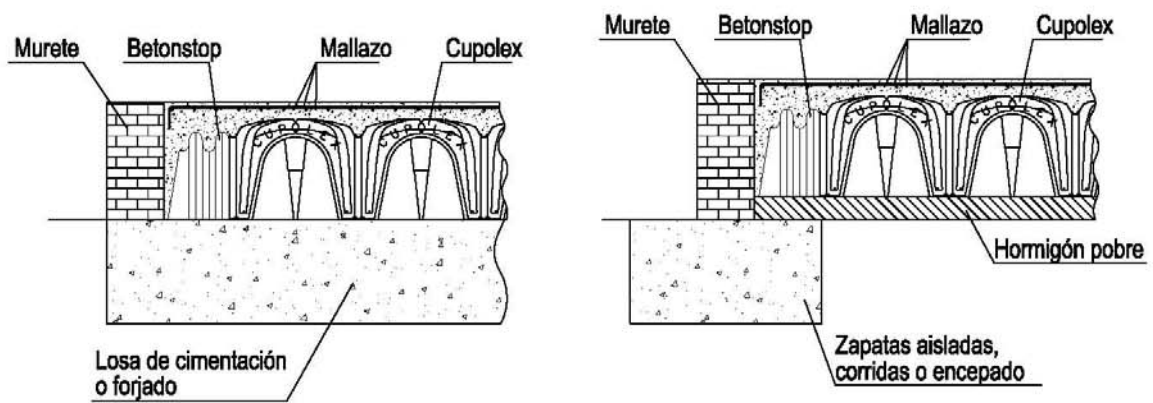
ENCUENTRO DE MURO YA EXISTENTE CON CÚPULA CORTADA
